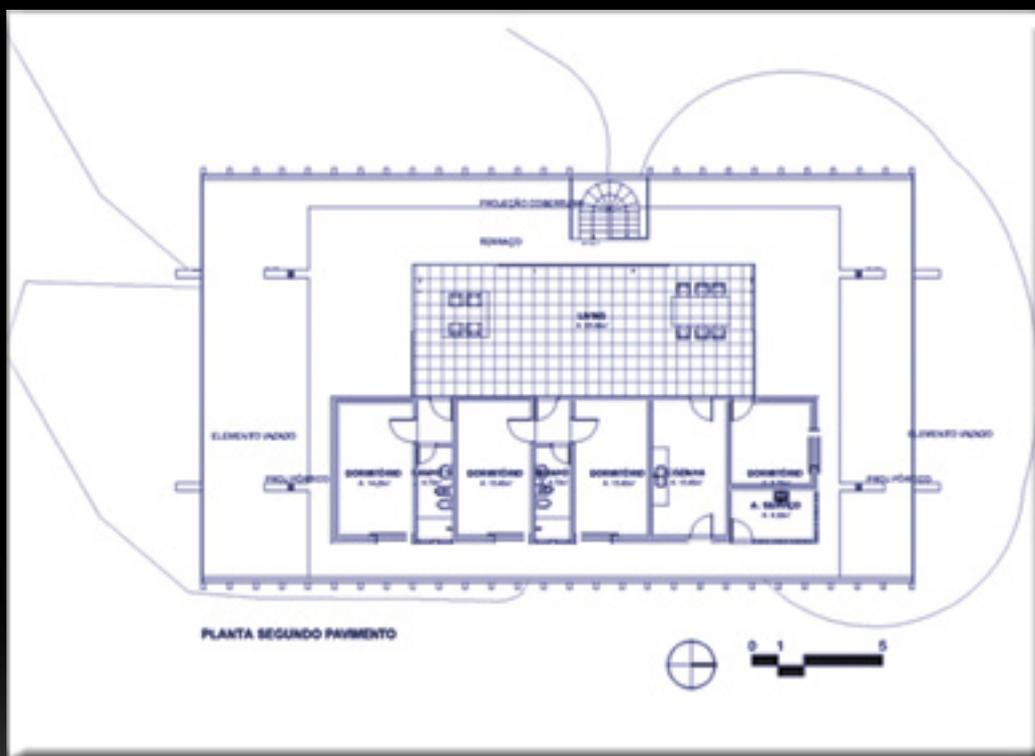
Planta baixa do pavimento superior da Residência Guido Weber, Caiobá. (1965).
